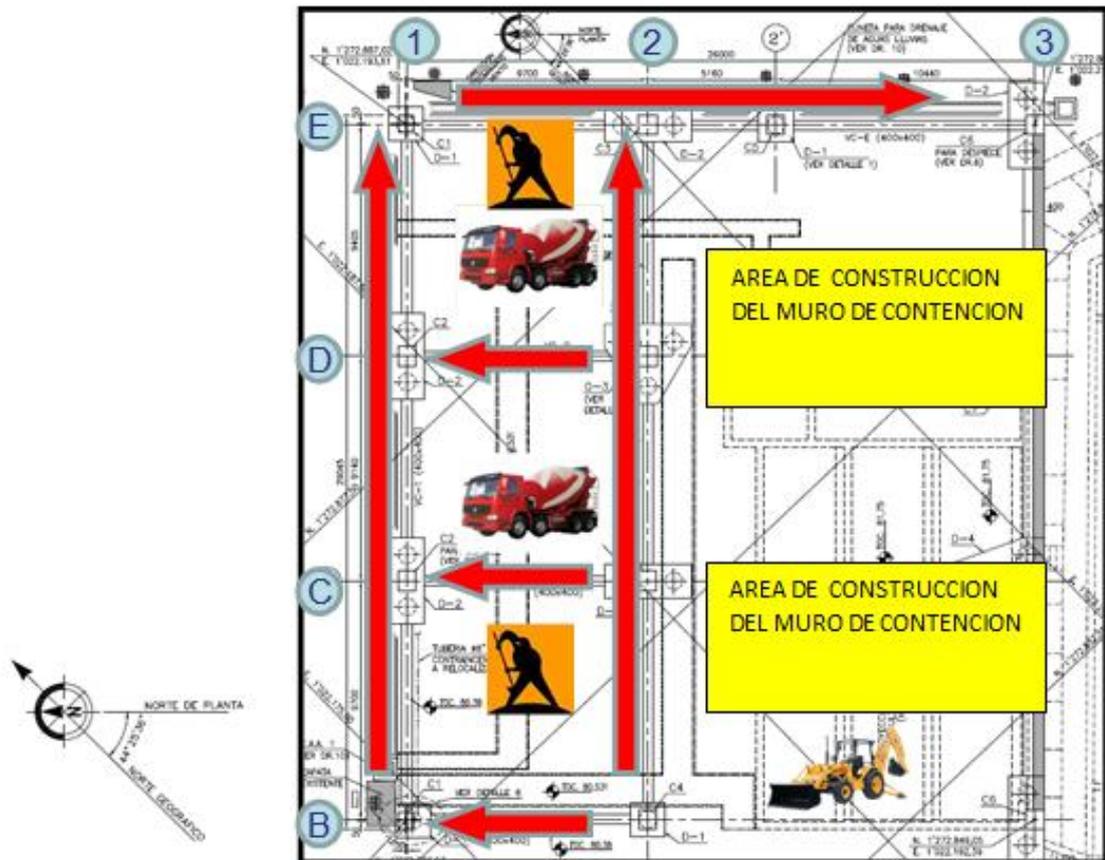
Plano en planta de bases de bombas Placa de piso Edificio UF/RO
